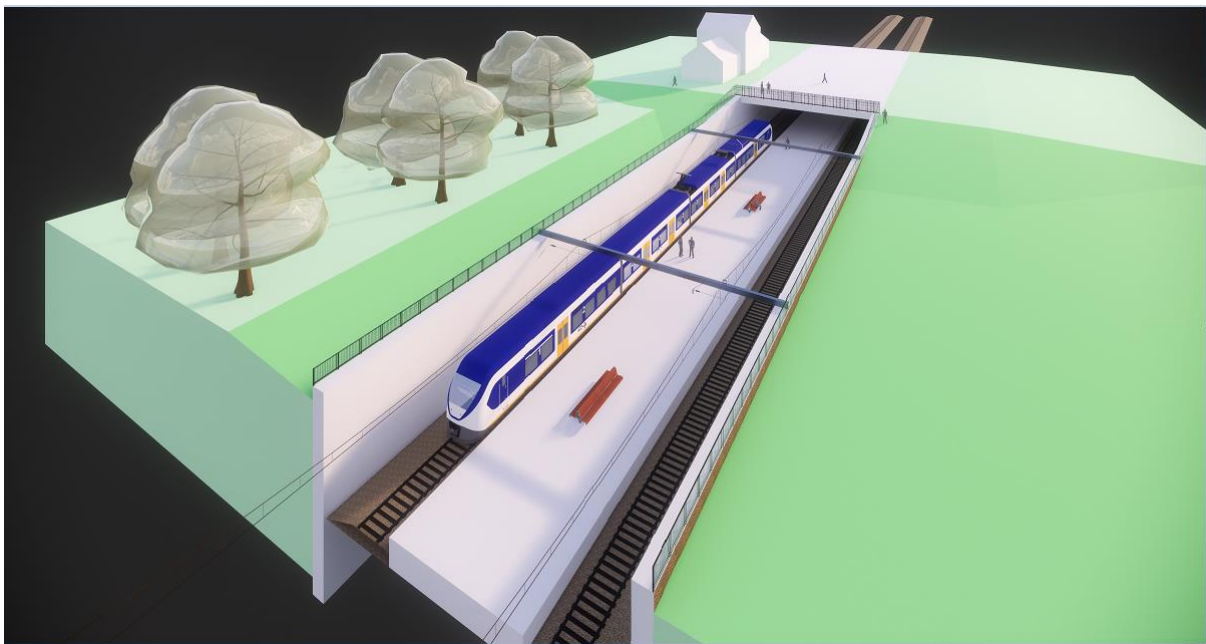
met in zicht komende elementen van de bovenleiding
